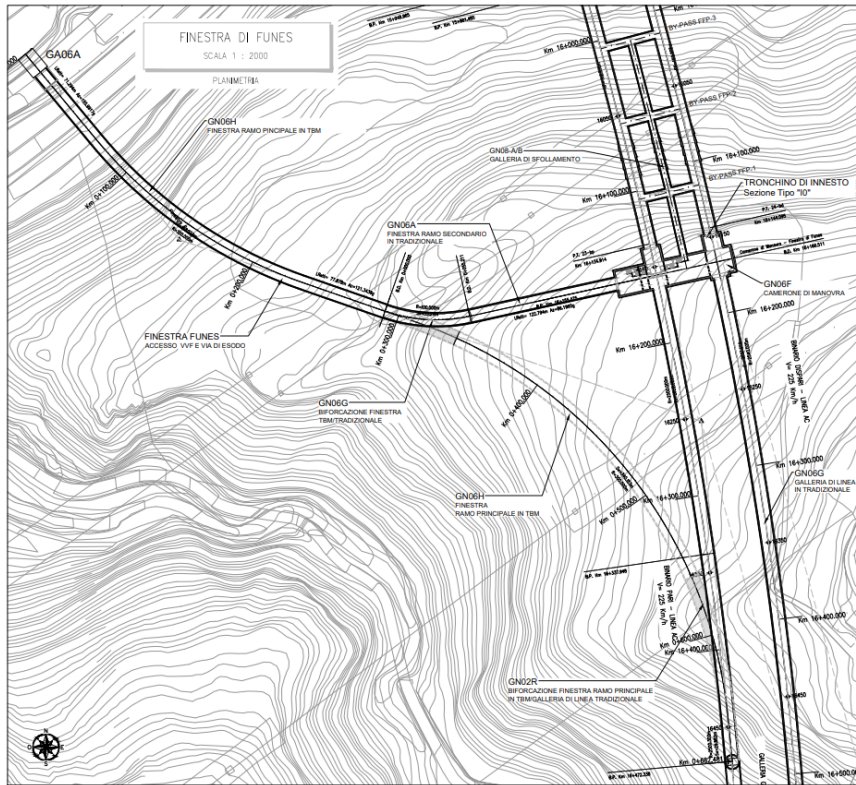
Vista planimetrica zona di innesto della finestra di Funes con la galleria di linea.
